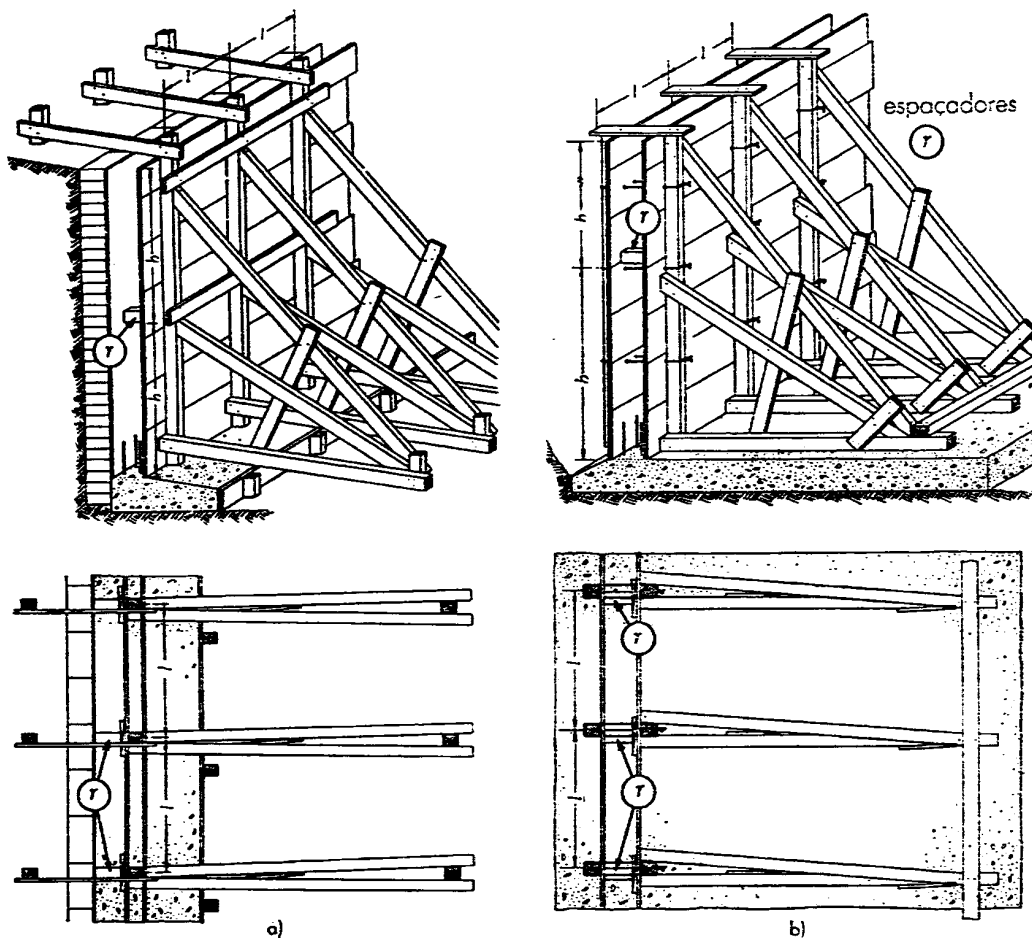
Detalhes de muros e espaçadores (Fonte: ABCP, 1943).
